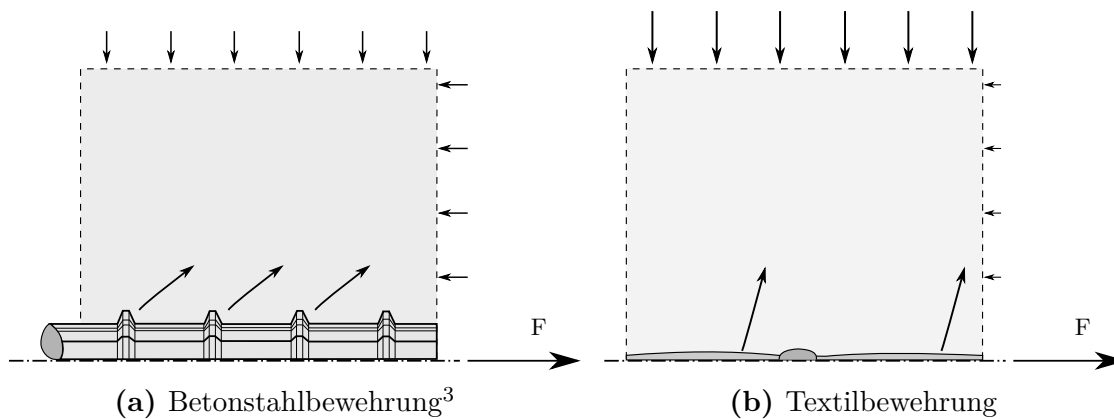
Resultierende Druckstrebe zufolge des Formschlusses der Bewehrung mit dem Beton
